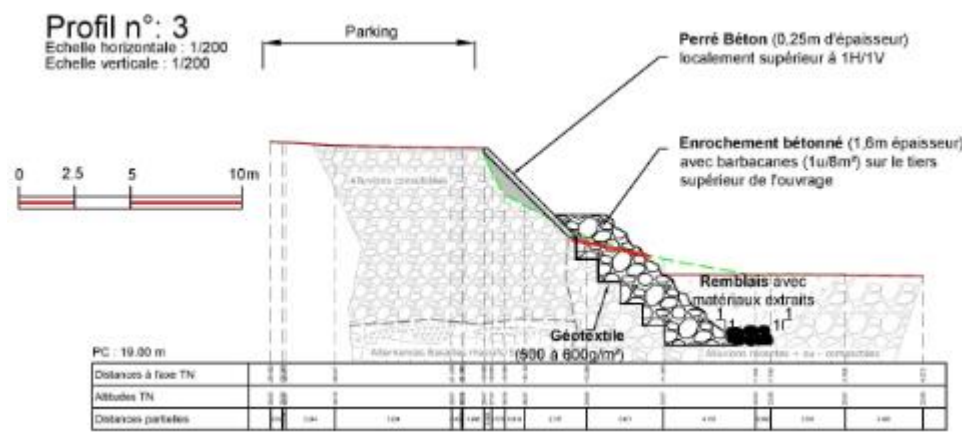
Coupe type particulière au droit du parking sur le tronçon 4 (source : SCP)
